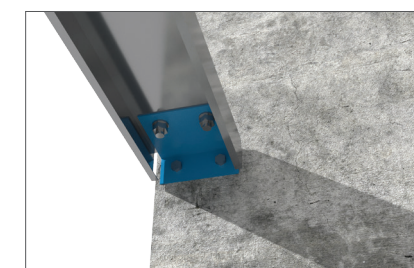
Detail styčníku profilu sloupu a jednoho nebo dvou ztužujících prvků. Ztužující prvky jsou připojeny k profilu sloupu pomocí připojovacích úhelníků a šroubů M16. Styčník musí být vždy vybaven vložkou mezi C profily, které tvoří profil sloupu. Profil ztužujícího prvku nemusí být stejné výšky jako profily sloupu. Doporučené minimální výšky profilů ztužení jsou uvedeny v tabulce 32.
